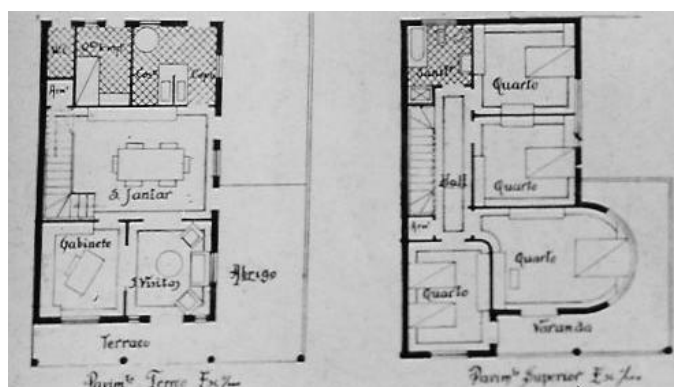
Planta Baixa de um projeto de autoria de Walter Gordilho.
